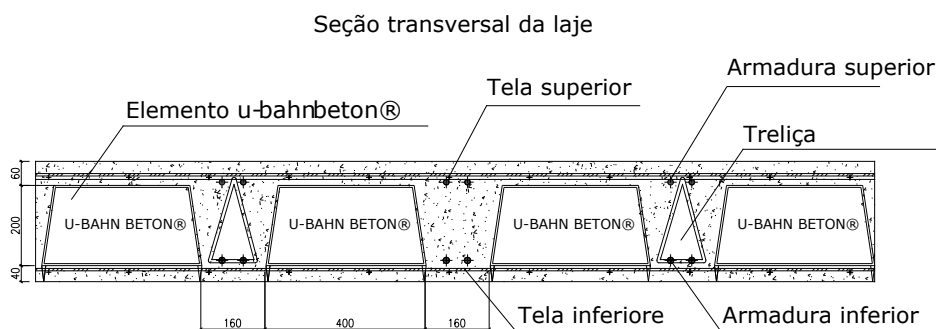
Seção transversal da laje *U-Boot Beton* (DALIFORM GROUP, 2015).
